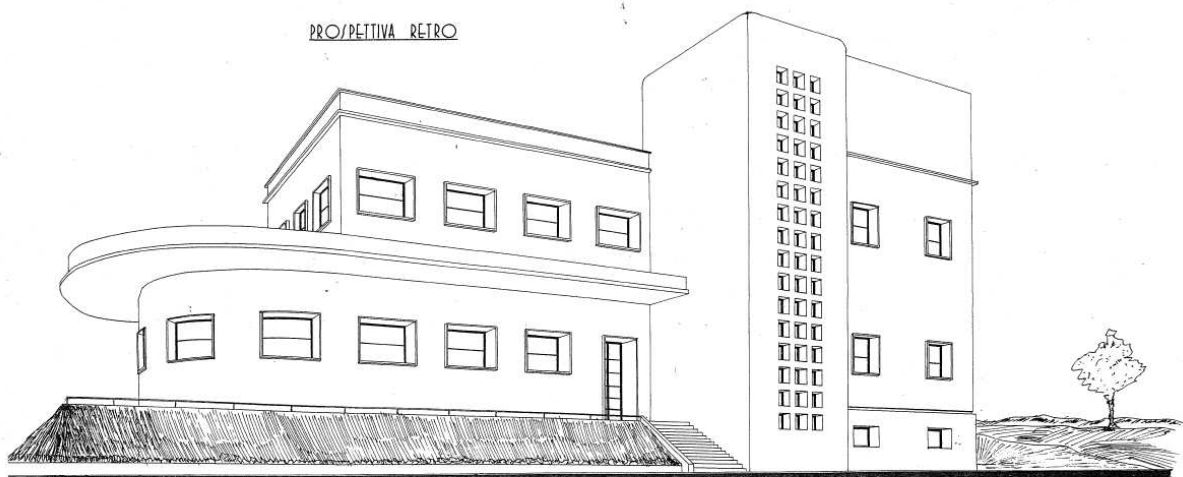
Prospettiva assonometrica della seconda versione del progetto, vista direzione Sud-Est
